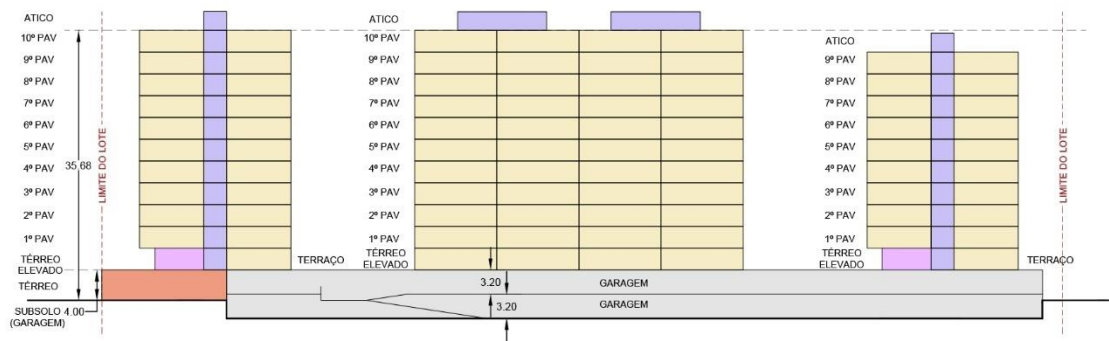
ESTUDO DE MASSA – LOTE 5 – PLANTAS E CORTE
